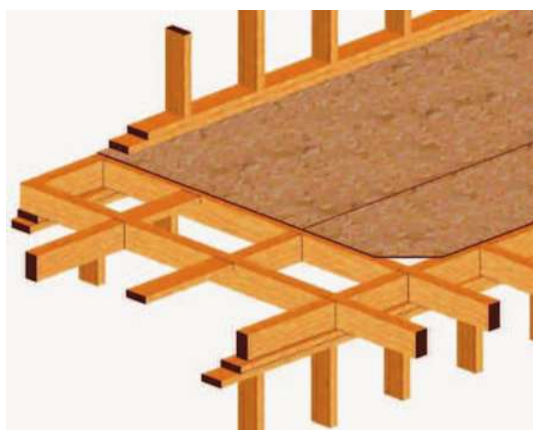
, Vigas apoyadas sobre soleras de amarre de los tableros. Fuente, “La Construcción de Viviendas en Madera”, p. 125
